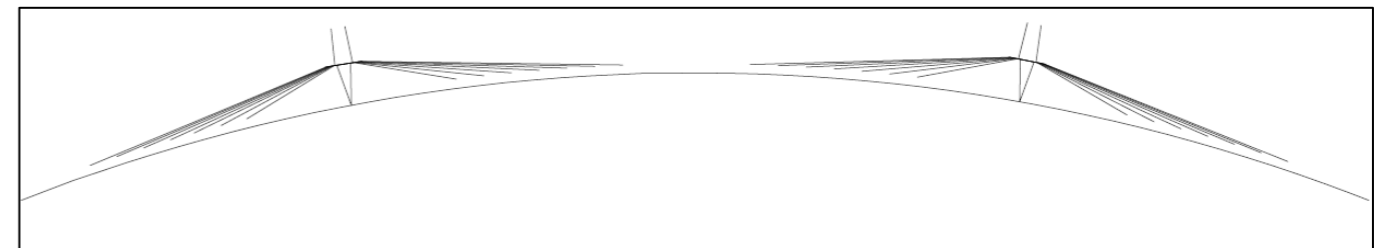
Vista en planta de las directrices de los elementos de la pasarela. Fuente: Elaboración Propia (AutoCAD)
